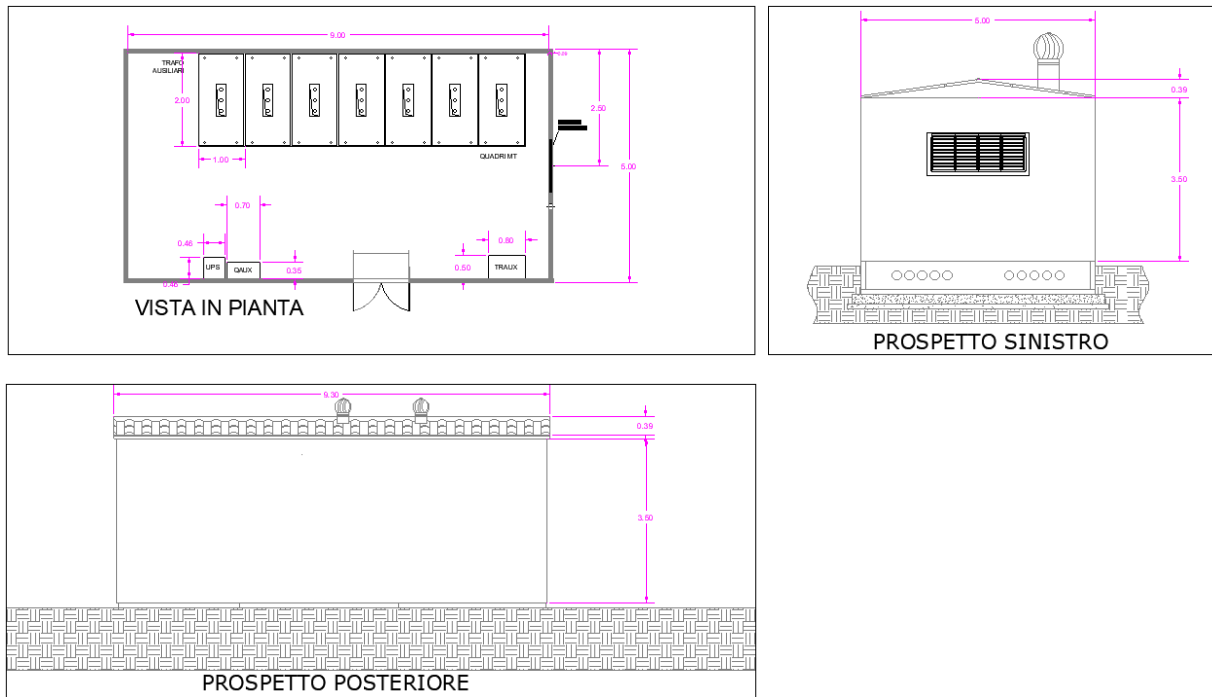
Pianta, sezioni e prospetti cabina di raccolta
